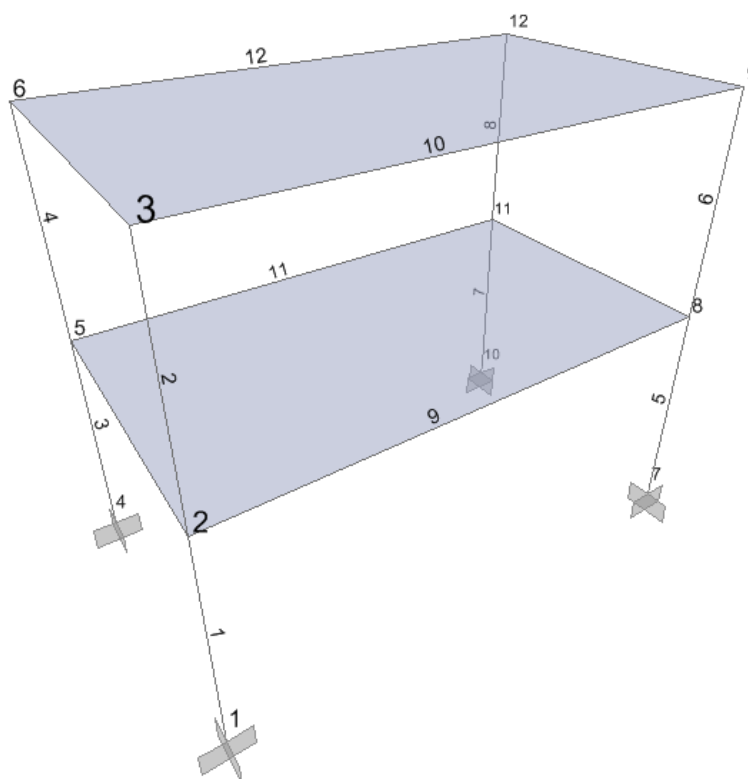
Etiquetação dos elementos e nós da estrutura – SAP2000
